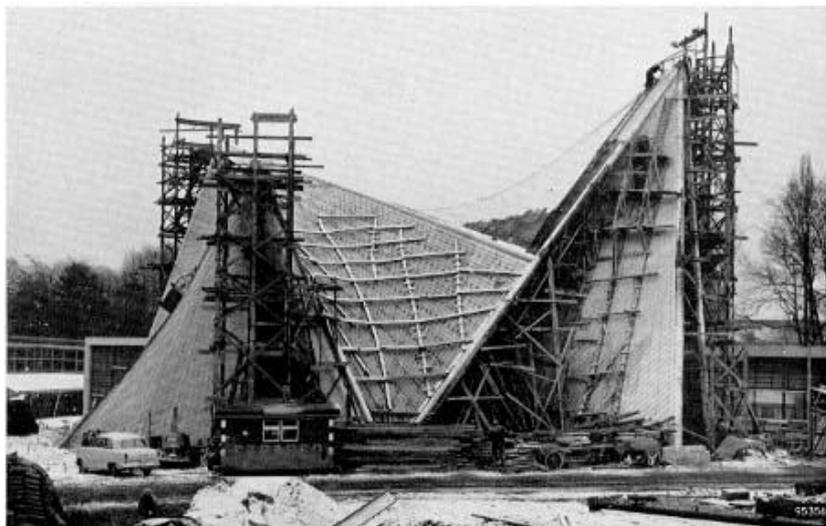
PAVILHÃO EM OBRAS
